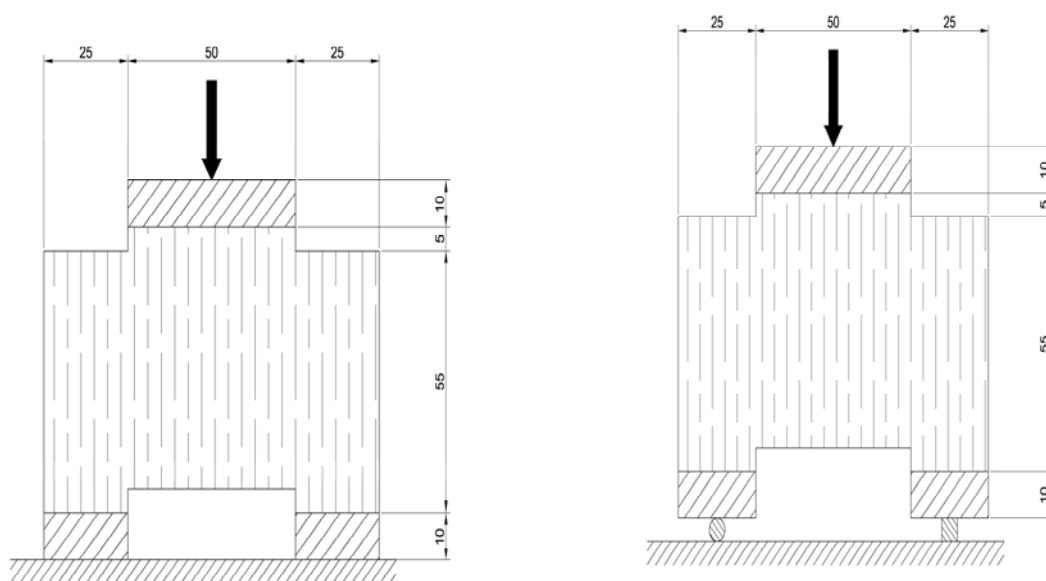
Modelos para ensaio de cisalhamento em dois planos
